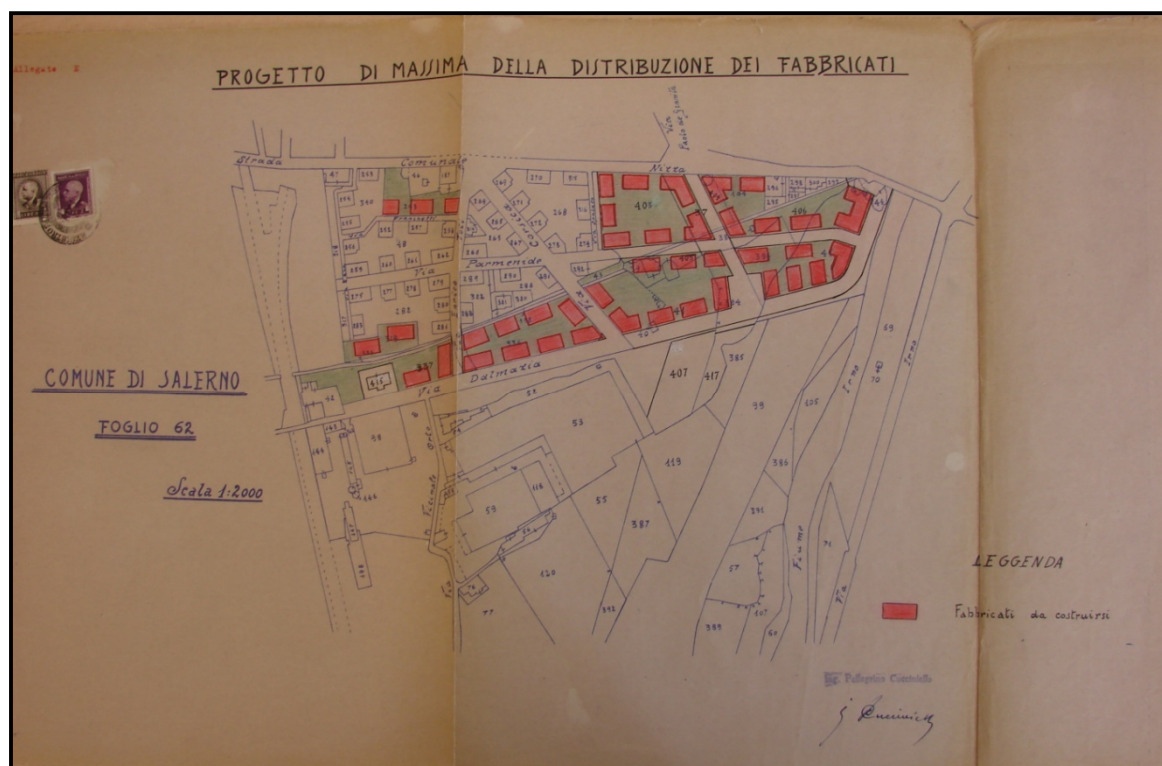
Stralcio planimetrico della zona del Rione dei Ferrovieri con l'individuazione dei nuovi fabbricati da costruire. Progetto dell'Ing. P. Cucciniello, 1946. Fonte ASCS.
